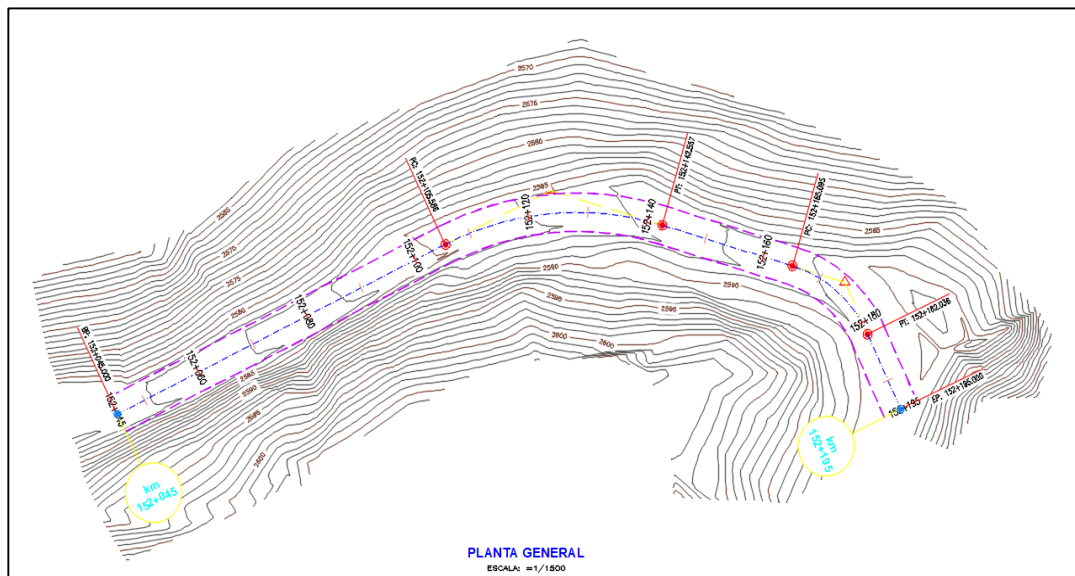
Plano en planta del sector de Agua Dulce - Kiteni.
